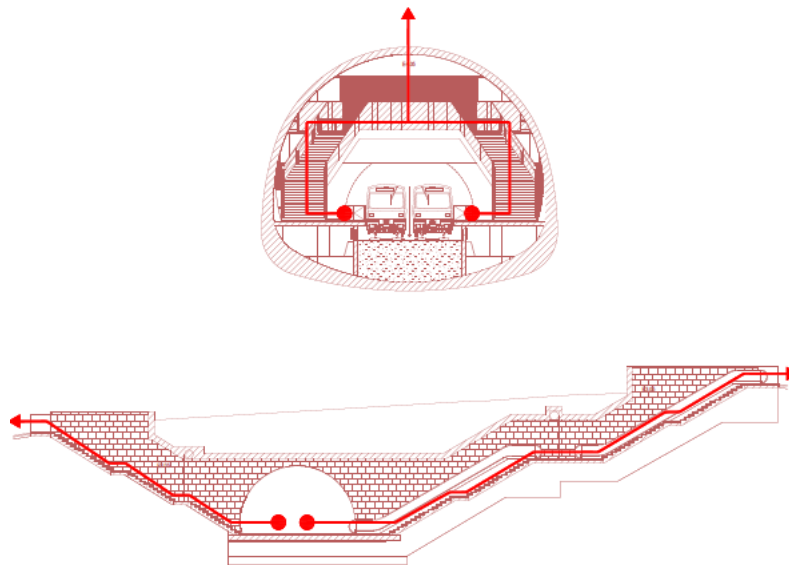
Estação Infante Santo, Cortes transversais (3 e 6) – esquema evacuação, saída Av. Infante Santo
